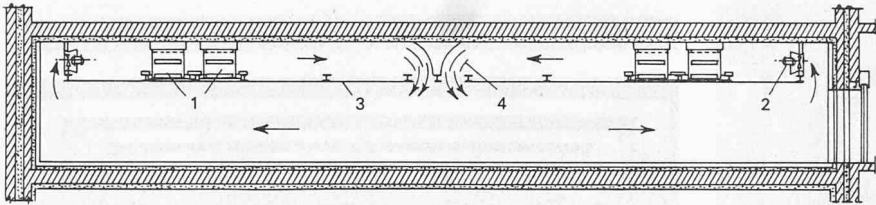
Längsschnitt durch den Schnellgefrieretunnel, 1:225
